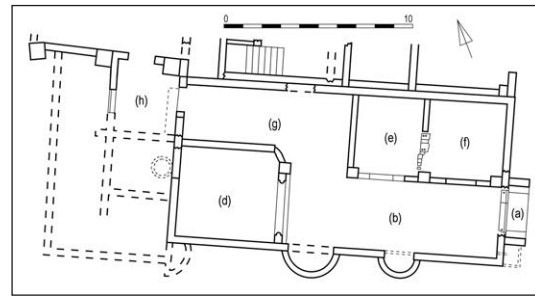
Domus su Via della Caupona, Grundriss
